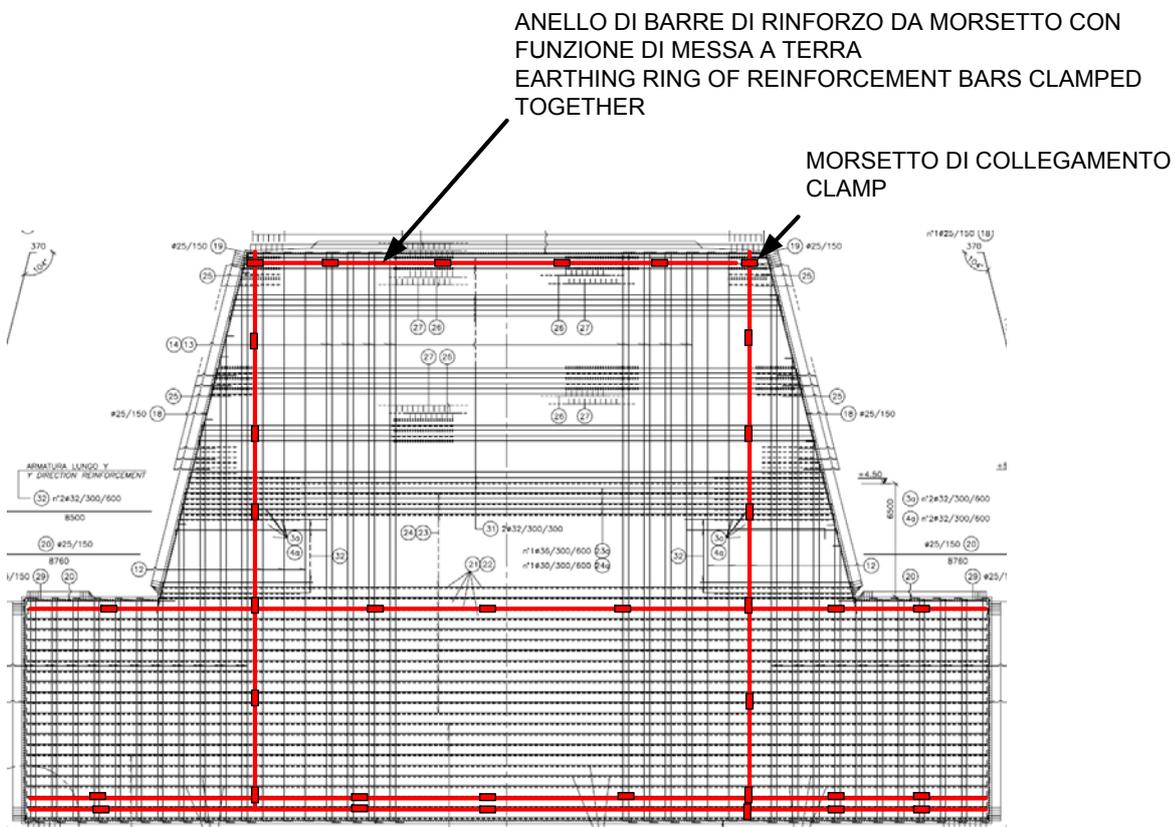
Principio dell'impianto di messa a terra per la fondazione della torre
